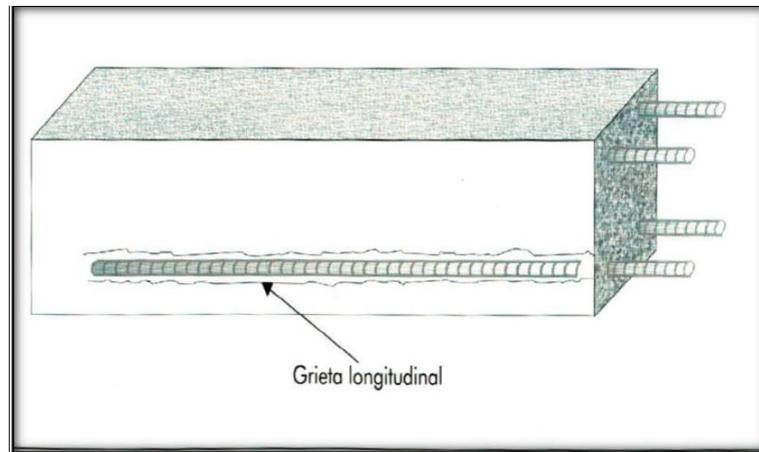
Grietas longitudinales por falta de adherencia.
